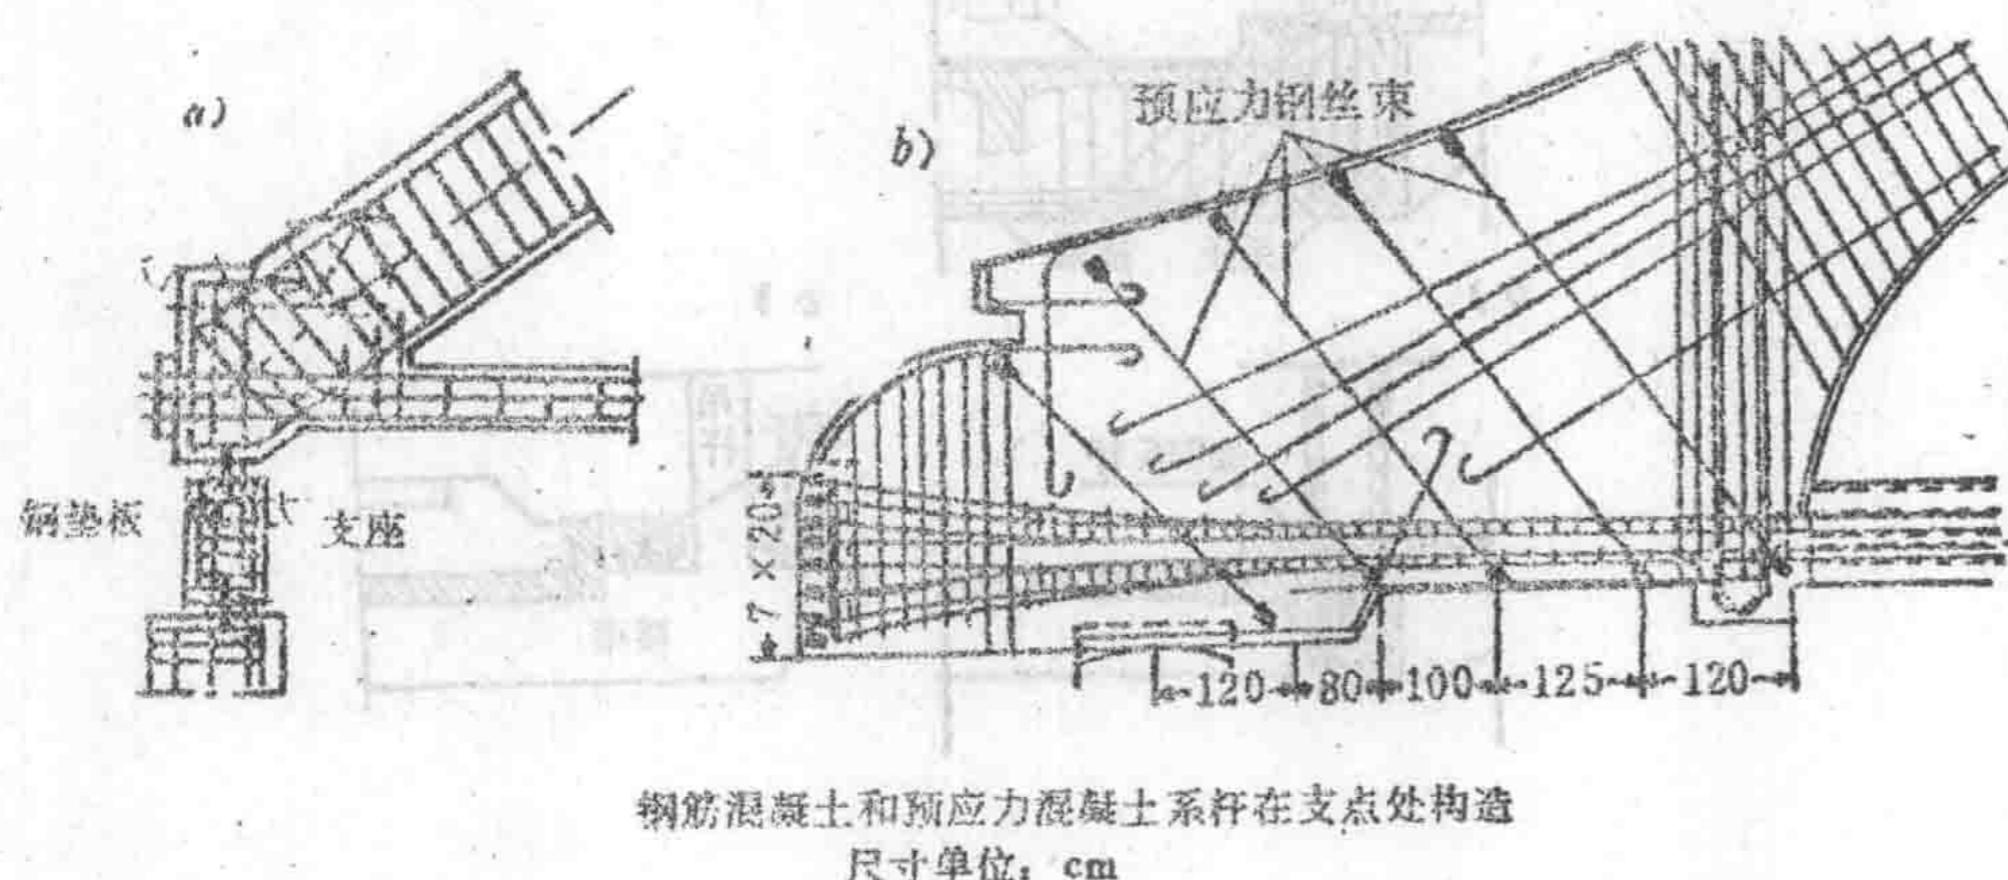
4 钢筋混凝土和预应力混凝土系杆在支点处构造
